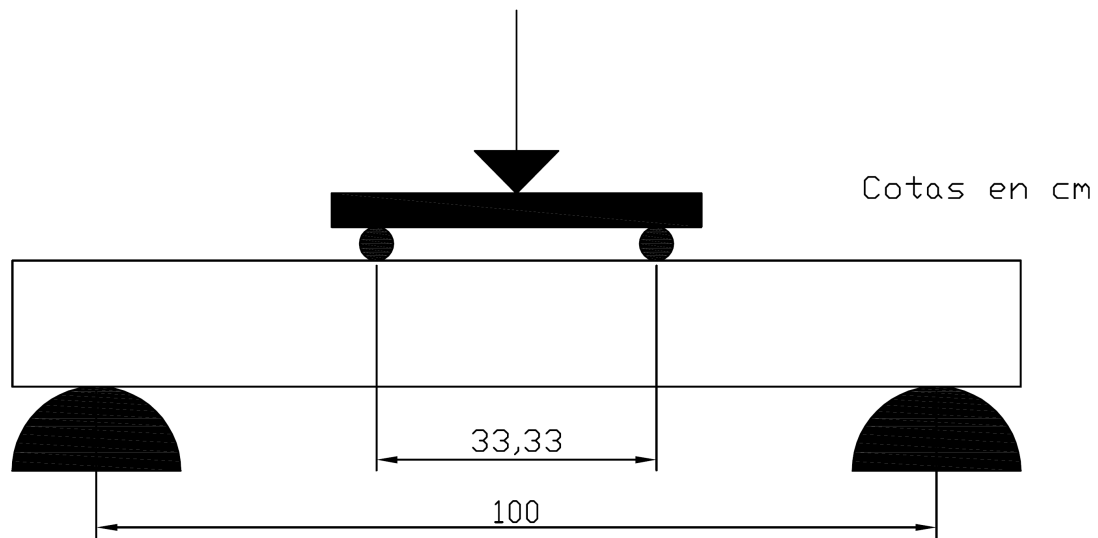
Disposición esquemática de las vigas para ensayar.
